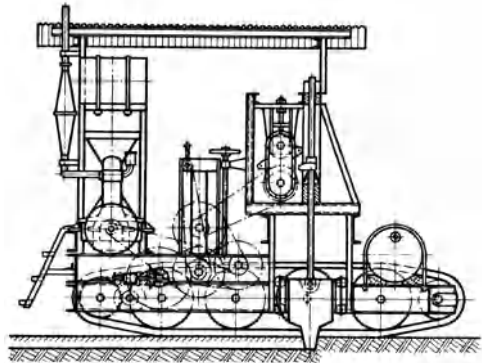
Stampfmaschine mit Freifallhämmer (Dinglersche Maschinenfabrik Zweibrücken).
